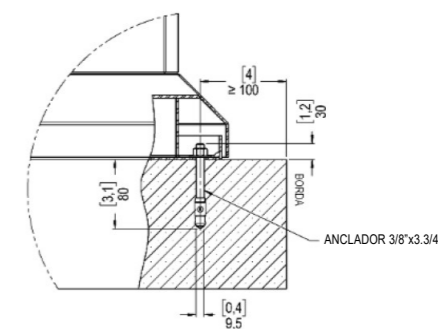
Detalle anclador tótem en pulgadas ["] y milímetros [mm]
